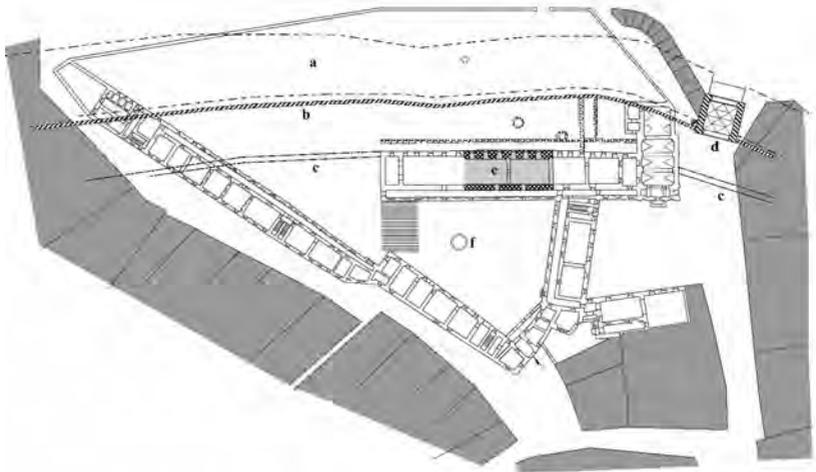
Der Königshof beim Hl. Benedikt (Králův dvůr u sv. Benedikta) in der Prager Altstadt, Grundriss des Burgareals: a) Stadtgraben – b) Zwingermauer – c) Stadtmauer – d) Pulverturm – e) Palast Wenzels IV. – f) Brunnen
